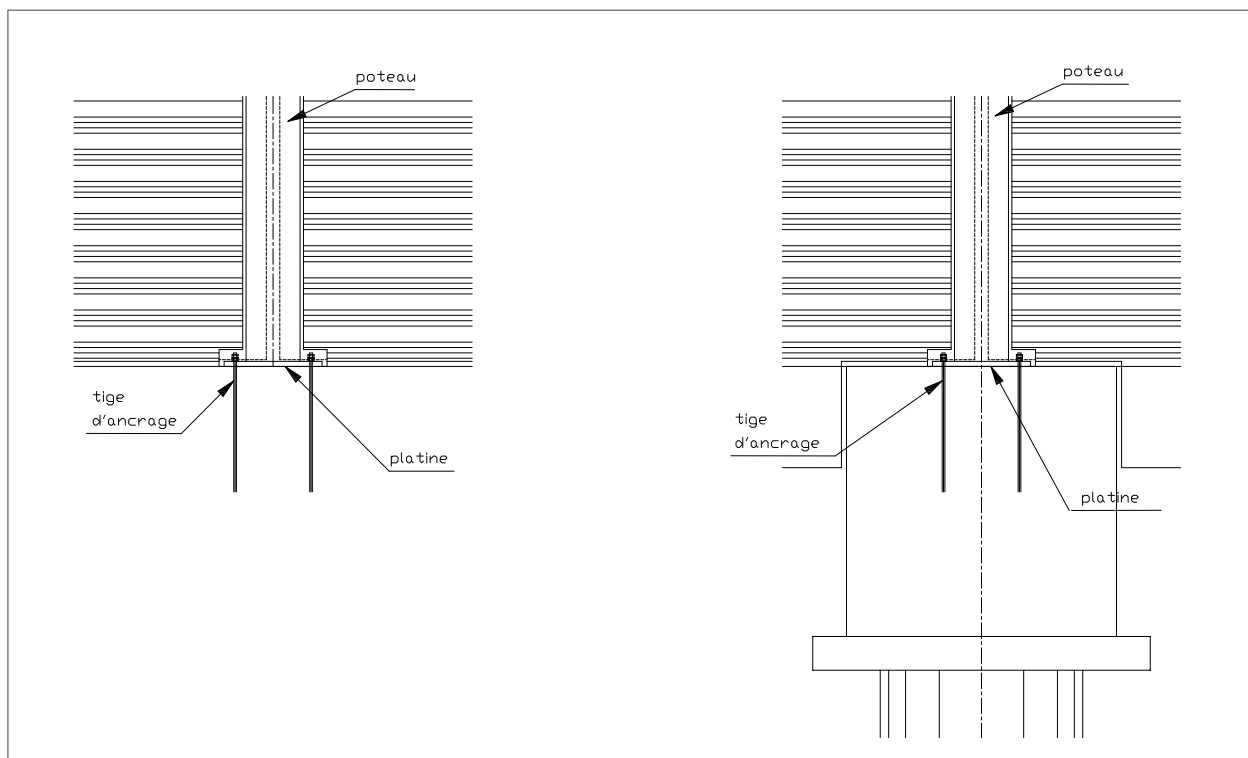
Ancrage des poteaux sur le dessus d'une fondation
